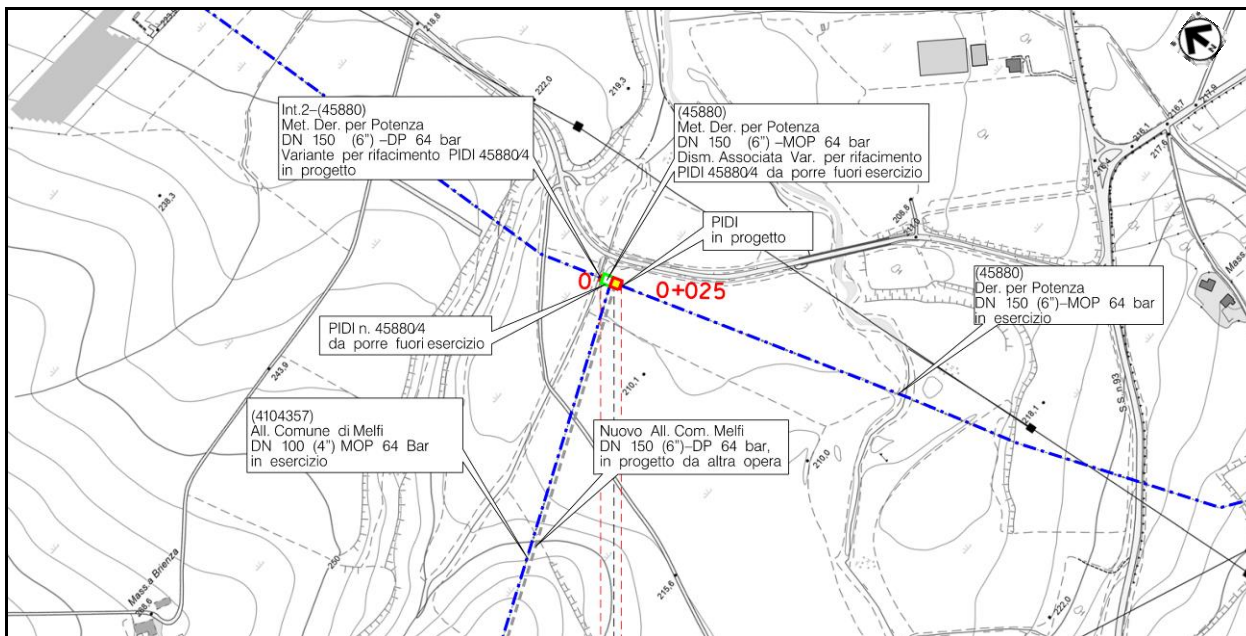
/B.b – Planimetria 1:5.000 con localizzazione dell'area dell'Intervento n.2 (progetto in rosso, dismissione in verde, esistente in blu)
